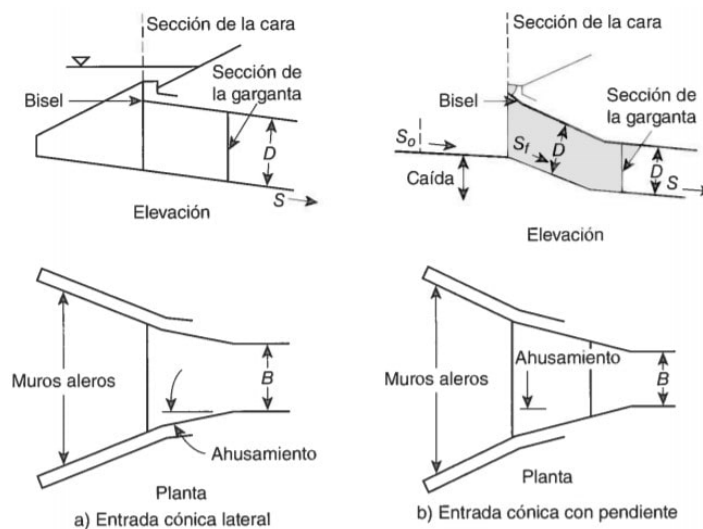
Vistas en planta y elevación de entrada cónica lateral.
